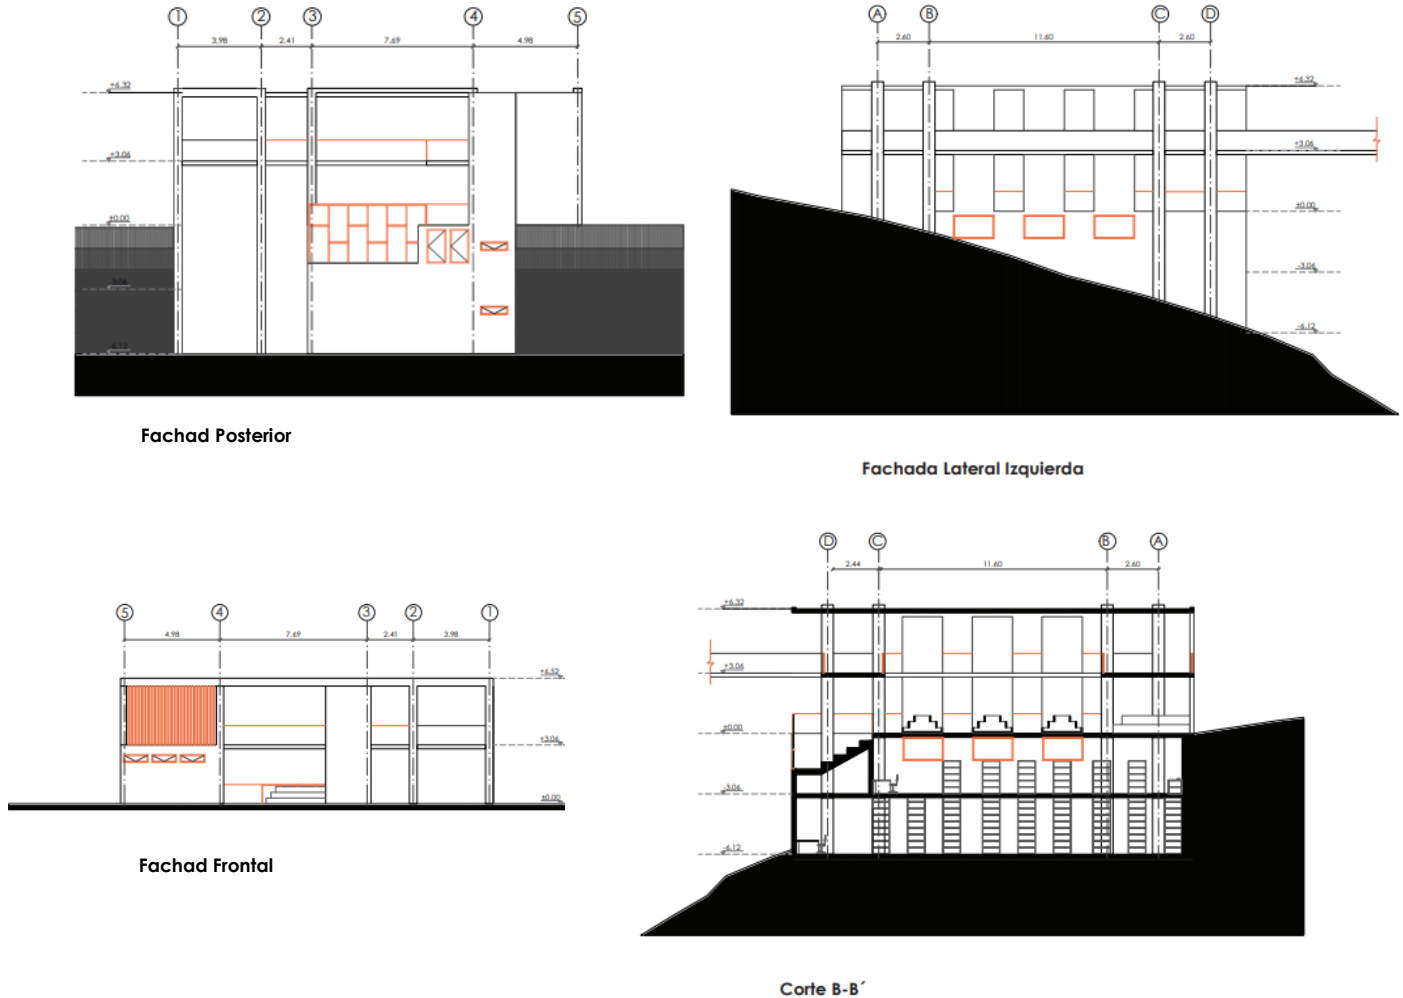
Fachada Posterior, Fachada Lateral Izquierda, Fachada Frontal y Corte Longitudinal Bloque 4, Puente Peatonal en el Parque Lineal El Condado. Elaboración propia
